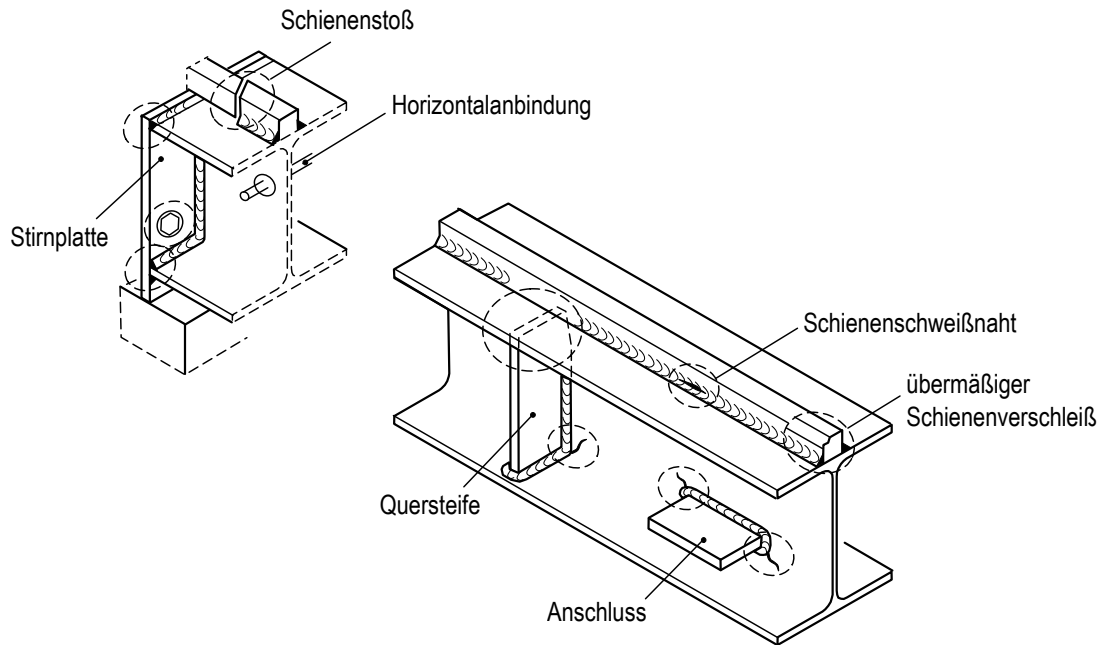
Beispiele für kritische Konstruktionsdetails eines Kranbahnträgers aus einem Walzprofil mit aufgeschweißter Schiene. Schematische Andeutung möglicher Risse.
